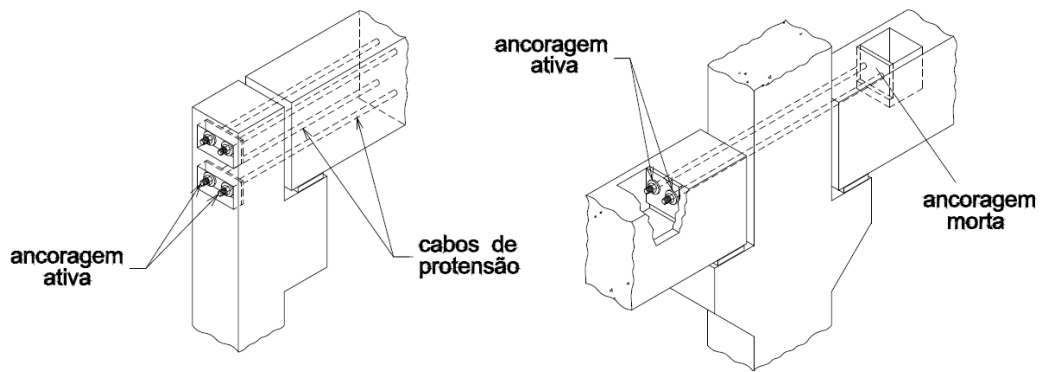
Ligações viga-pilar rígidas com cabos de protensão [El Debs (2000)]
